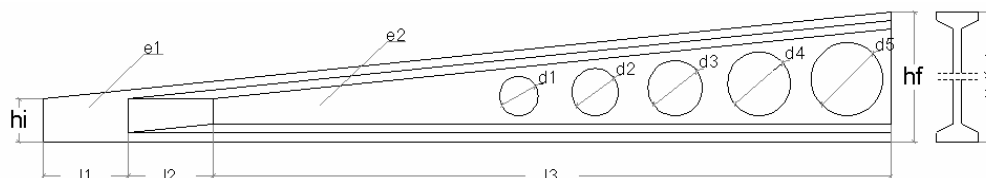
Secção longitudinal e transversal da “VMC20”.
